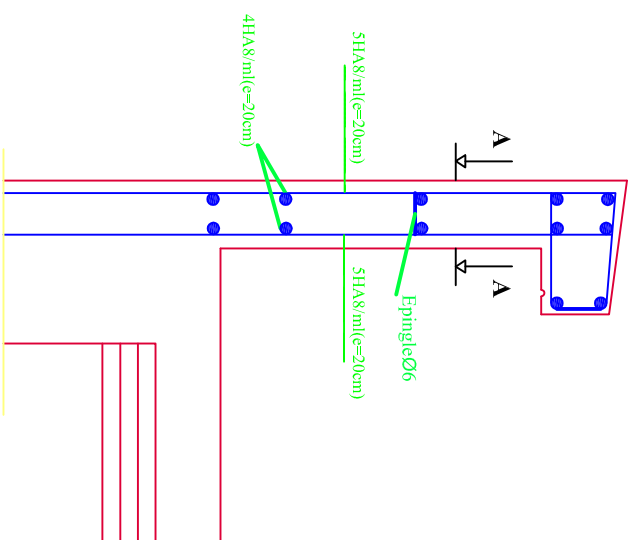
Ferrailage du voile périphérique (coupe verticale)
